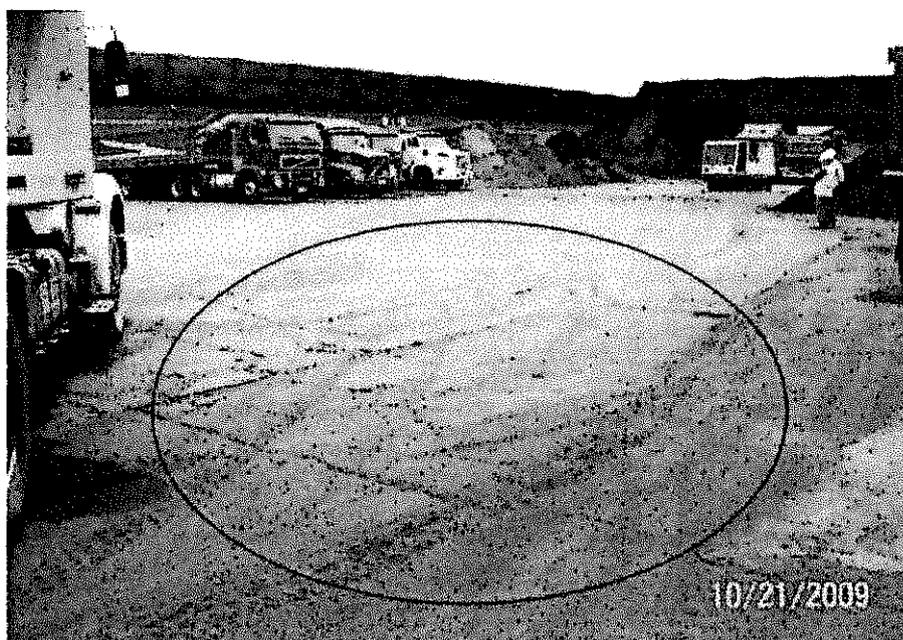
Losa de concreto de la parte central del depósito de concentrados (Patio 3). Nótese las fisuras y rajaduras del piso.
